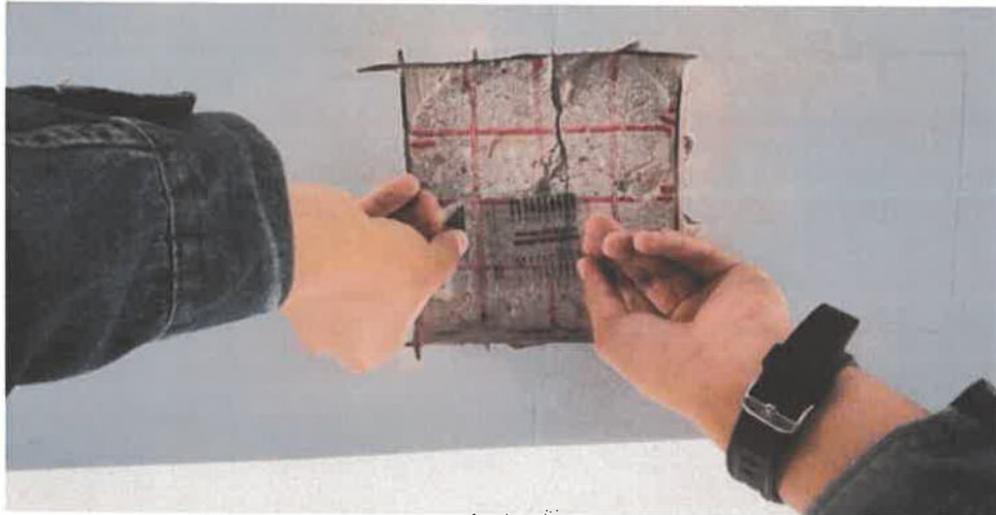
Las fisuras por flexión generalizada en vigas de 1.00mm son muy graves en una estructura, por falta de acero por flexión.
